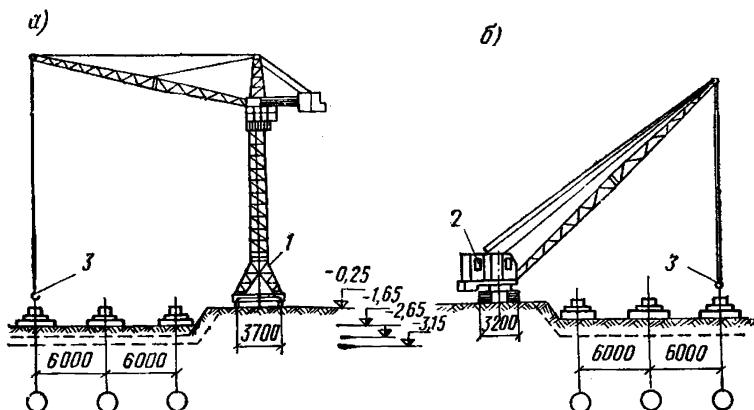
Схемы бетонирования фундаментов с помощью кранов
